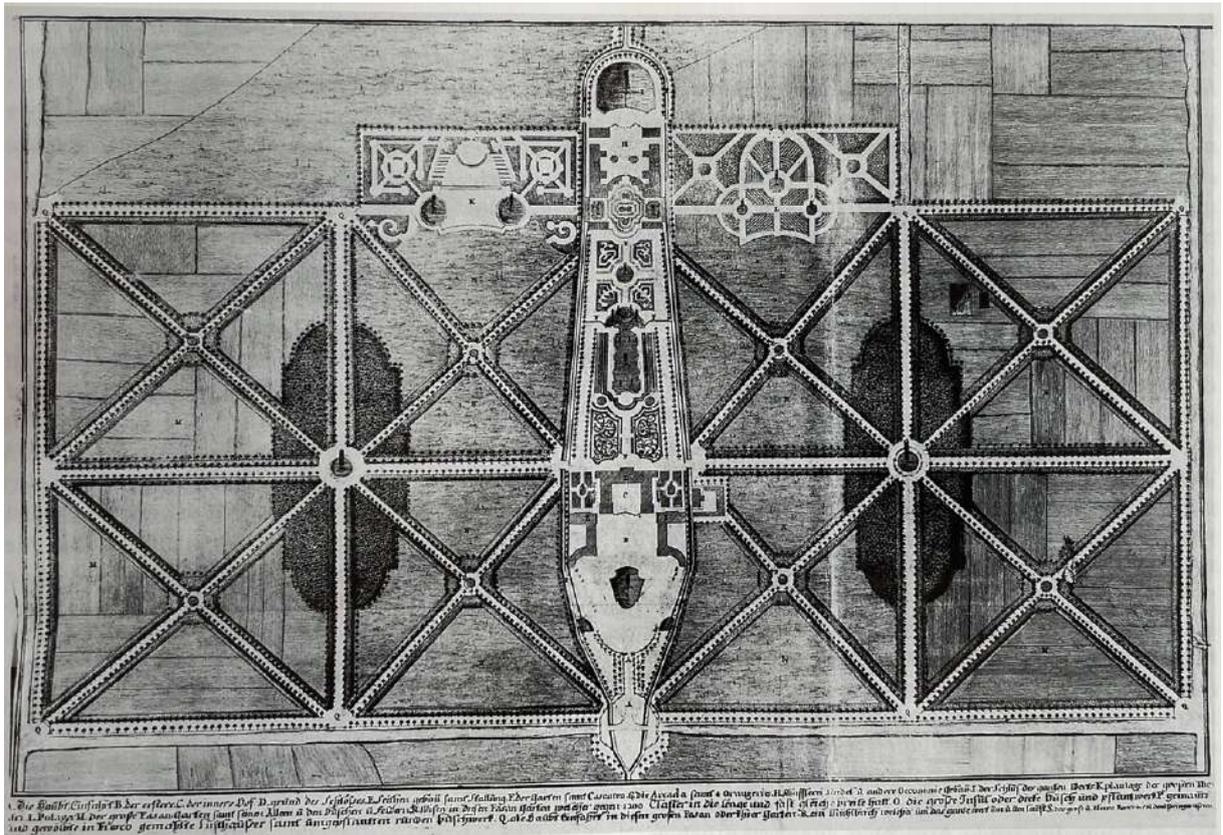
Salomon Kleiner, Grundriss Schloss Schönborn, Stadt- und Landesbibliothek Wien.
